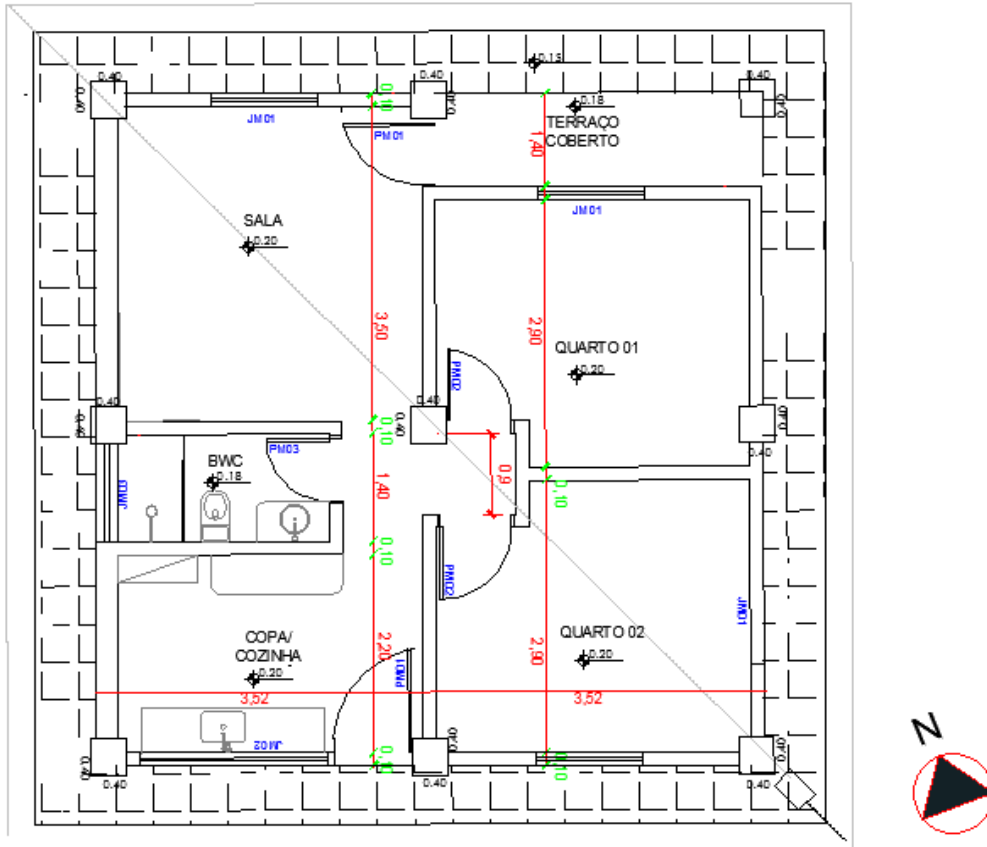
Planta baixa do pavimento térreo da Eco Residência
